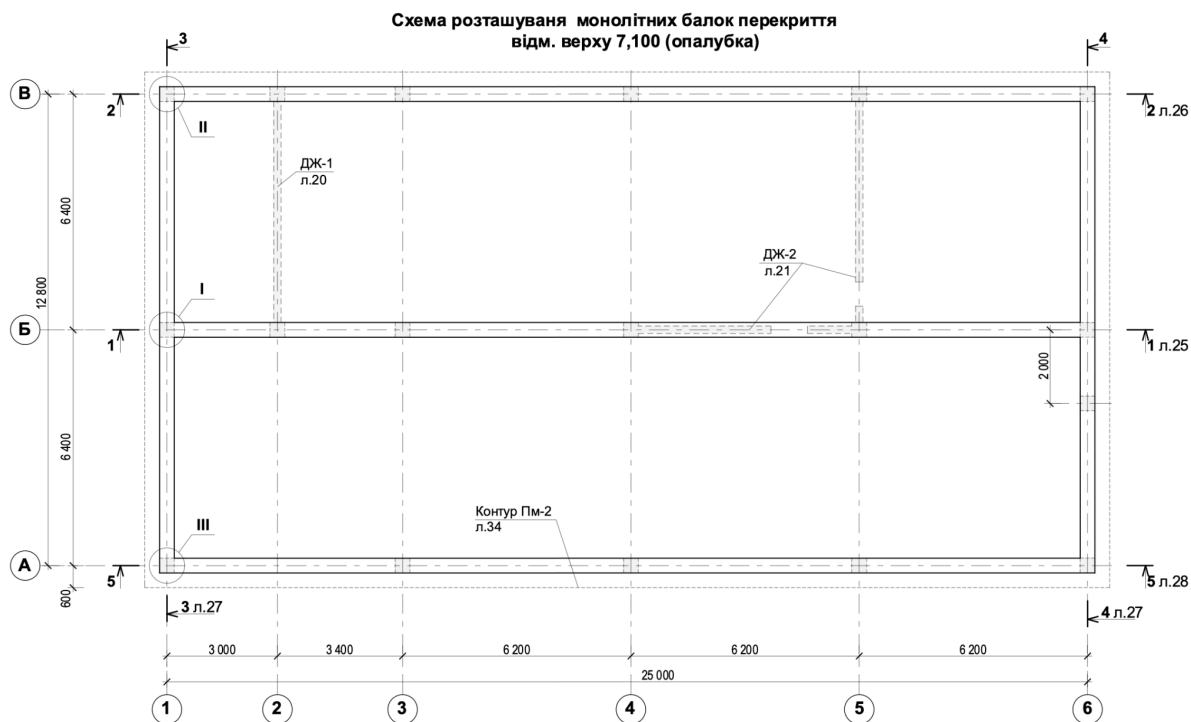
Схема розташування монолітних балок перекриття
